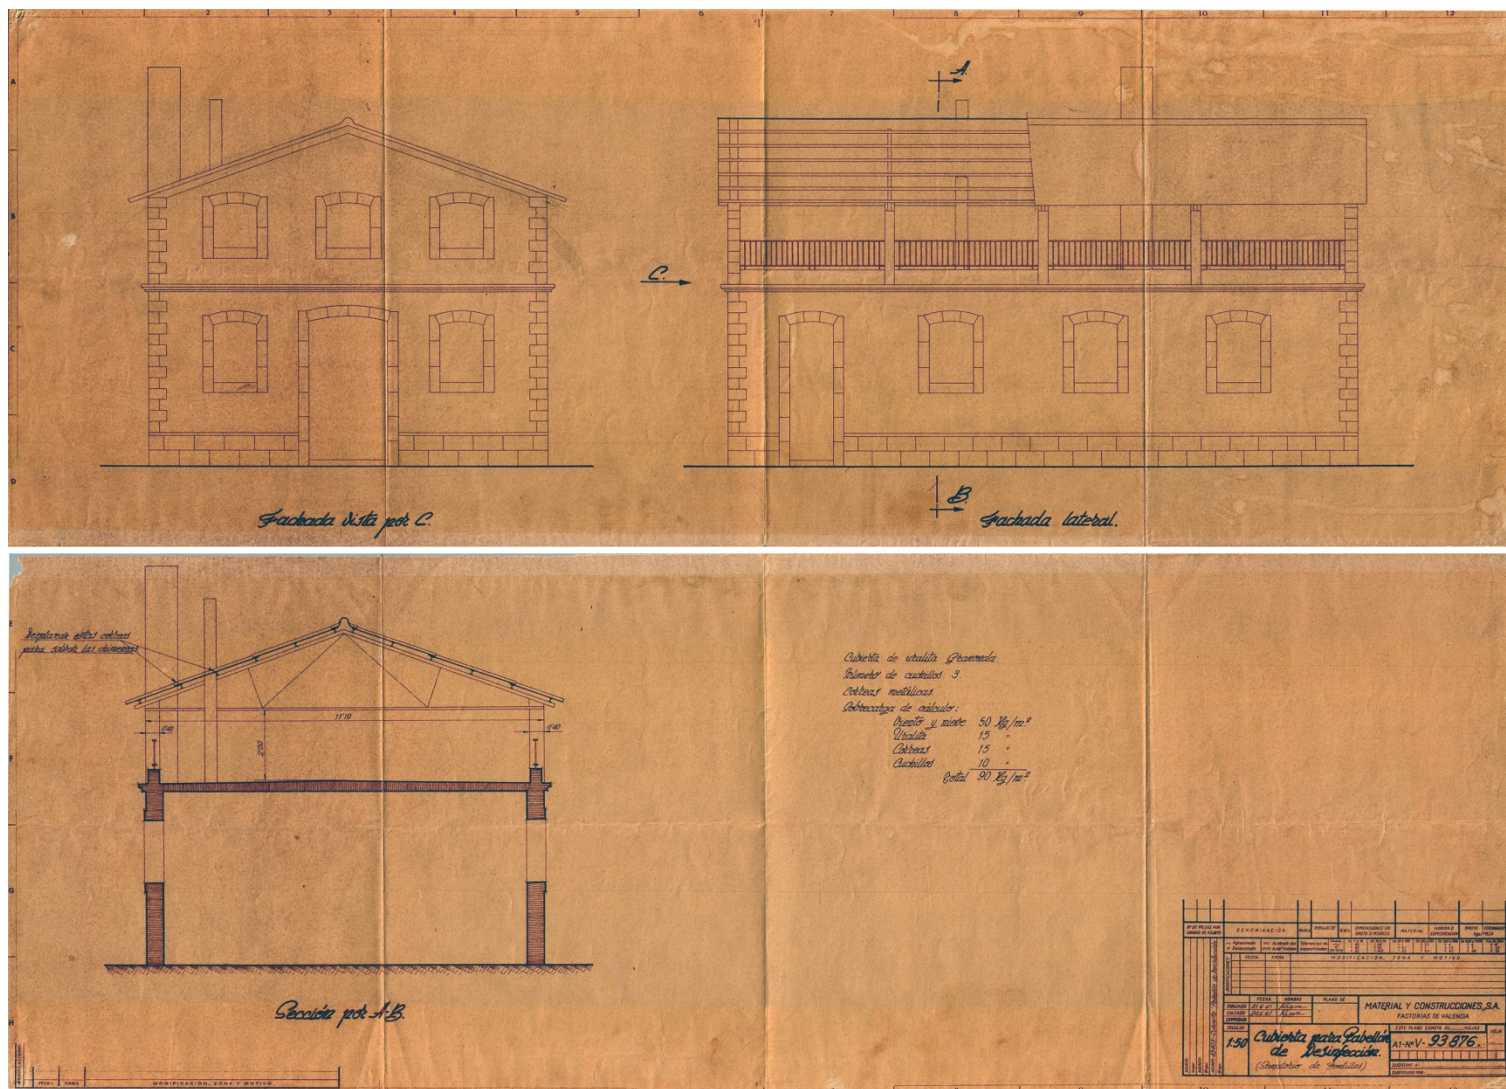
Planos de proyecto de Cubierta para el Pabellón de Desinfección. Alzados y sección. Empresa Material y Construcciones SA. 21 junio 1961.<sup>499</sup>
